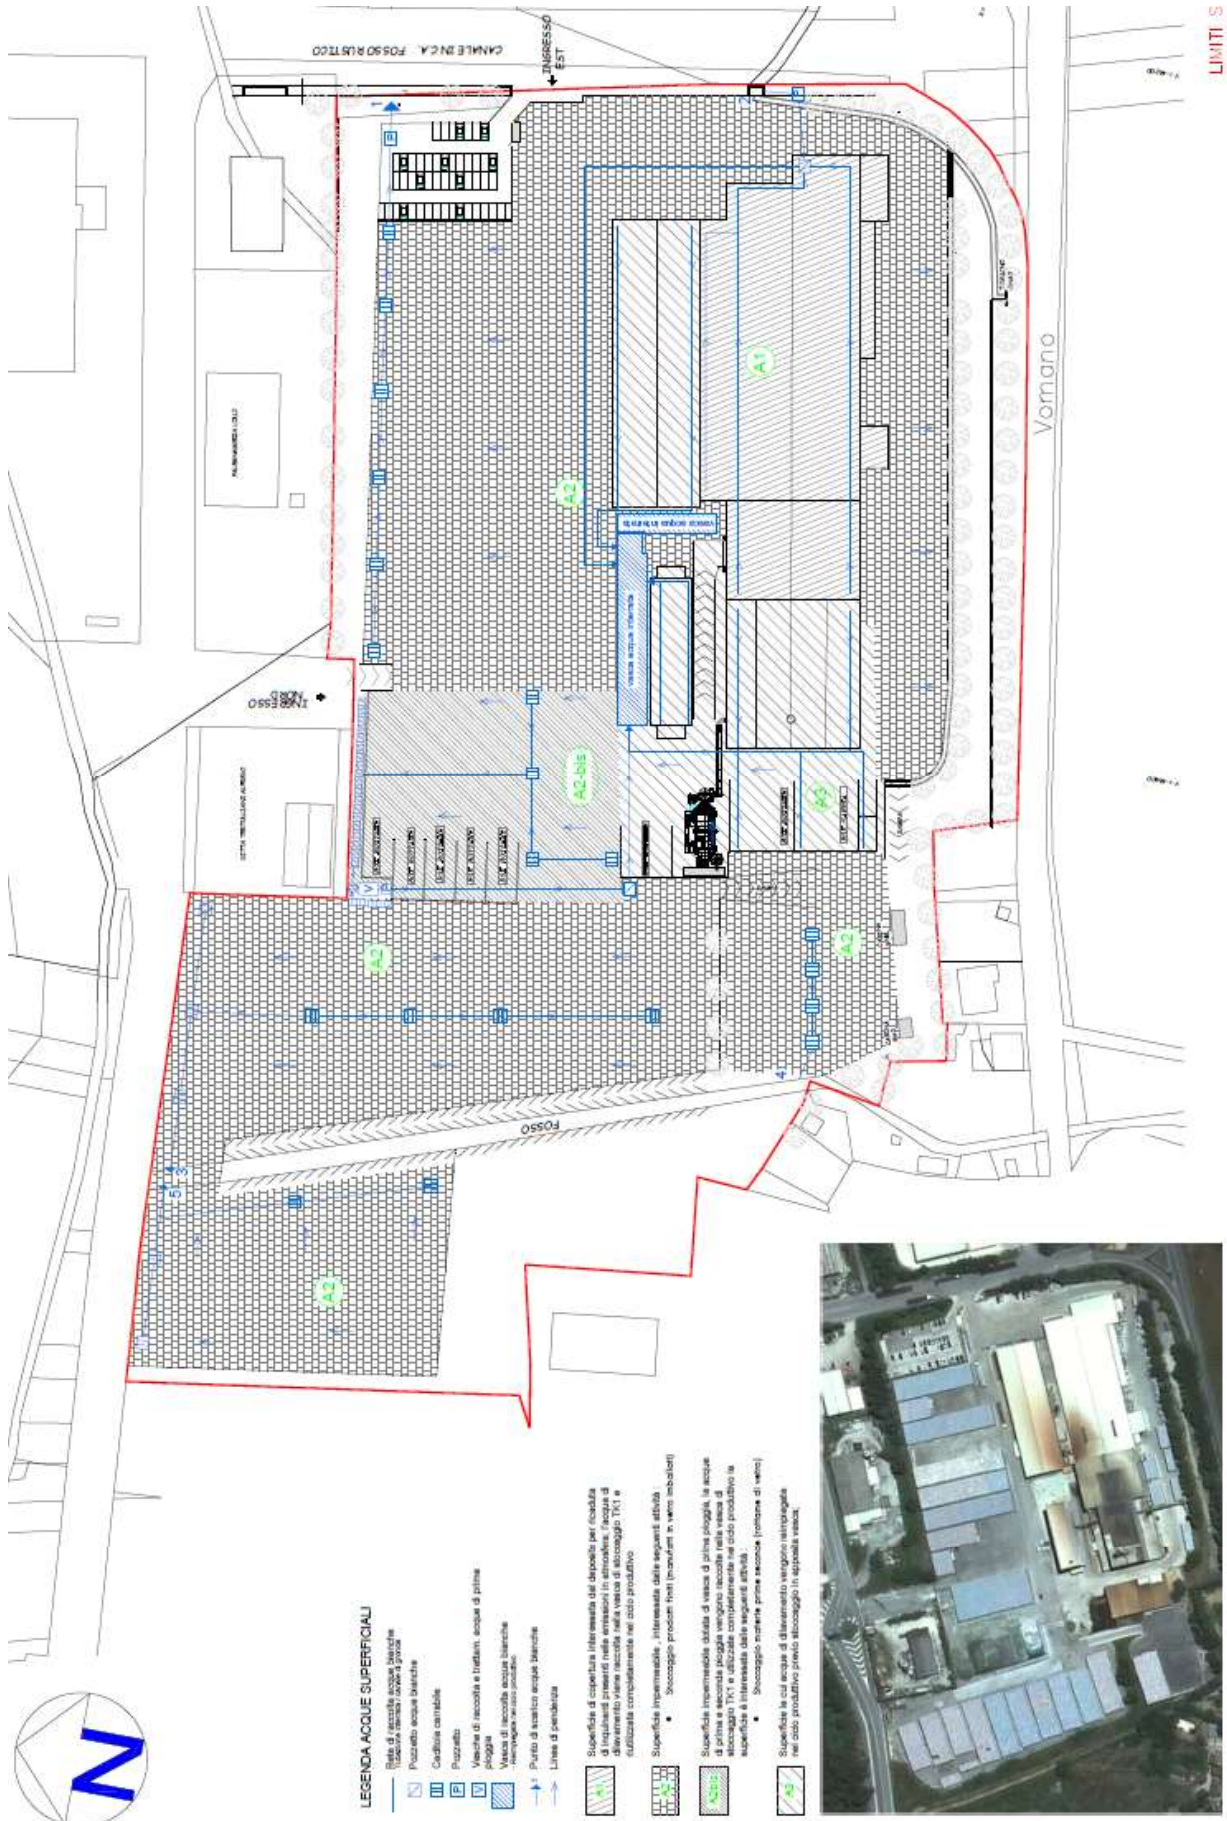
Planimetria superfici scolanti fase messa a regime, progetto avviato
